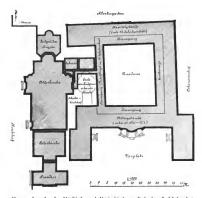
Lageplan der Abteikirche und Abteigebäude am Ende des 18. Jahrhunderts.
